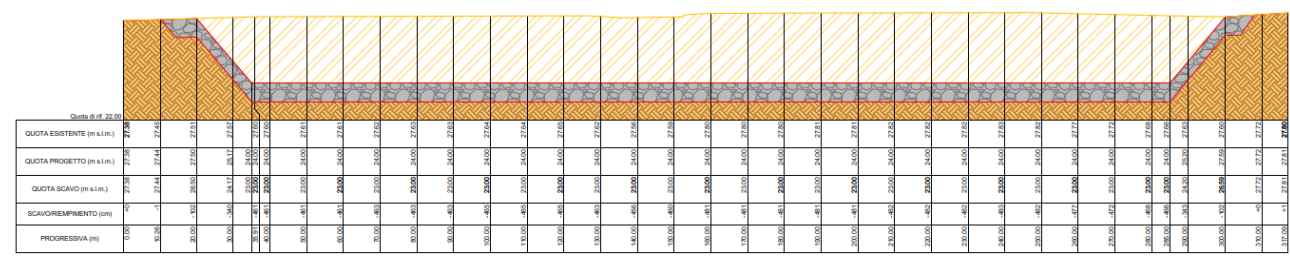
Profilo longitudinale di progetto del pennello. Estratto della tavola PF.0.2.7.PRG.GE.S.Z.0.0.2.A
